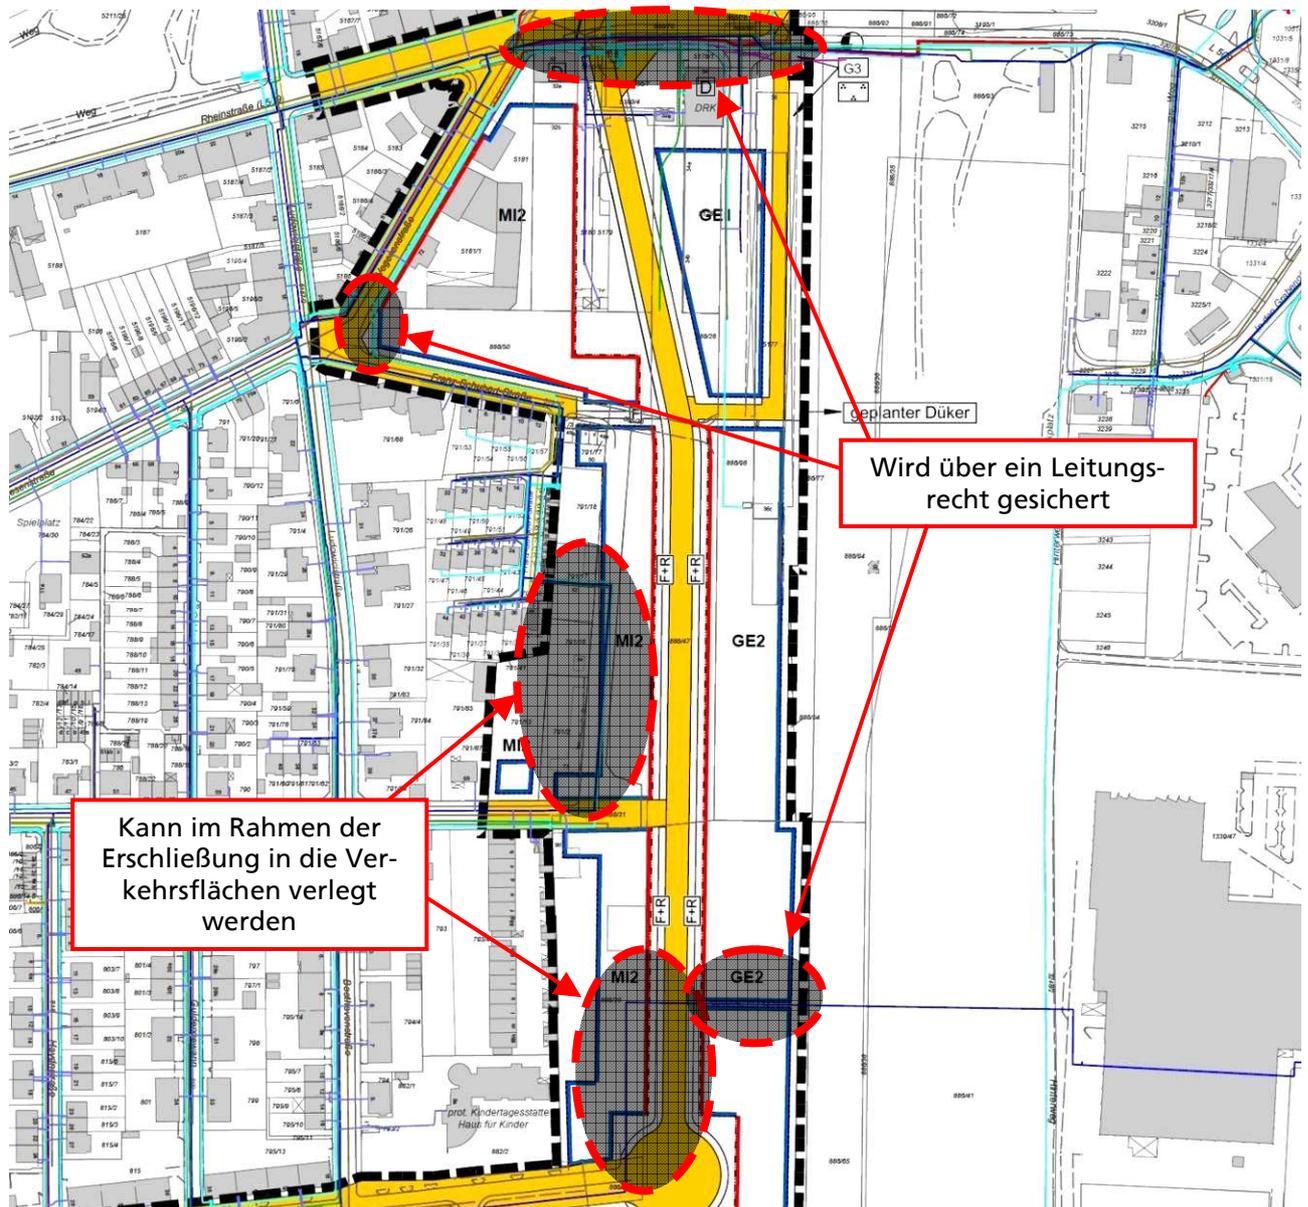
Relevante Bereiche zur Berücksichtigung im Planverfahren (ohne Maßstab), Stand 19.04.2011
